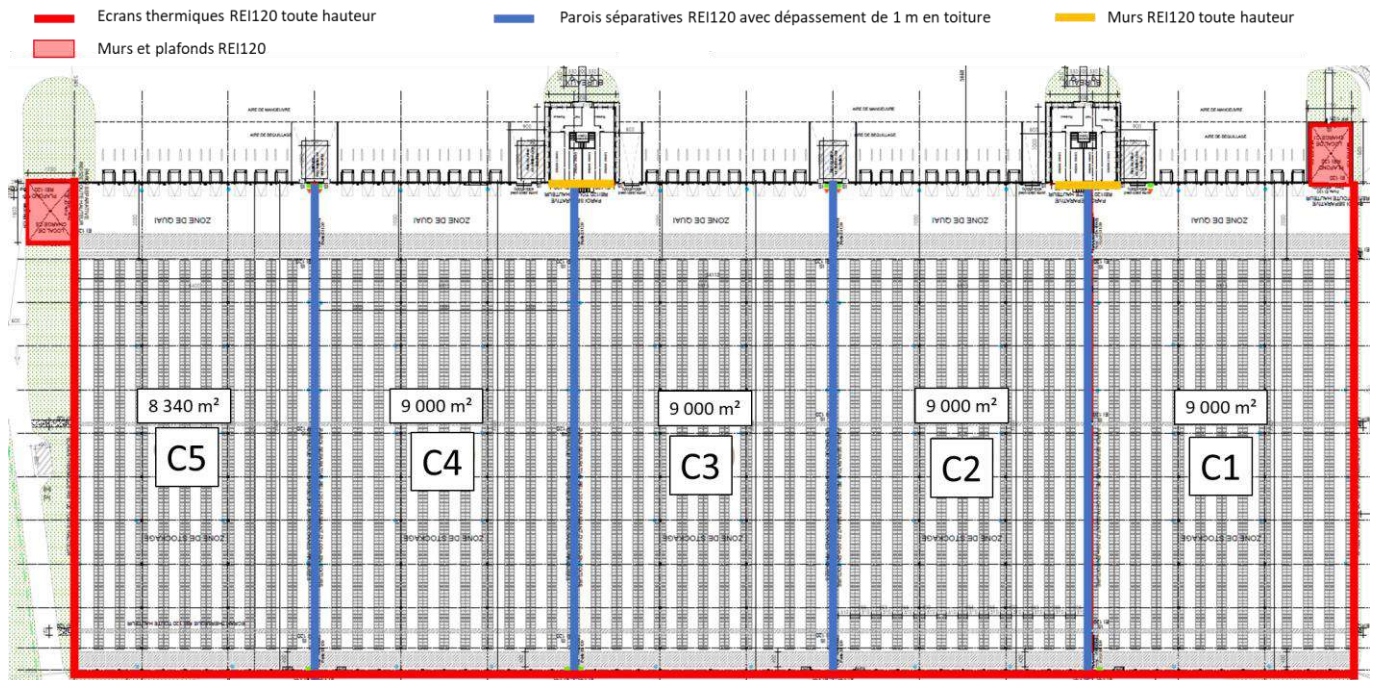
Plan des murs coupe-feu (source : dossier de demande d'enregistrement)
